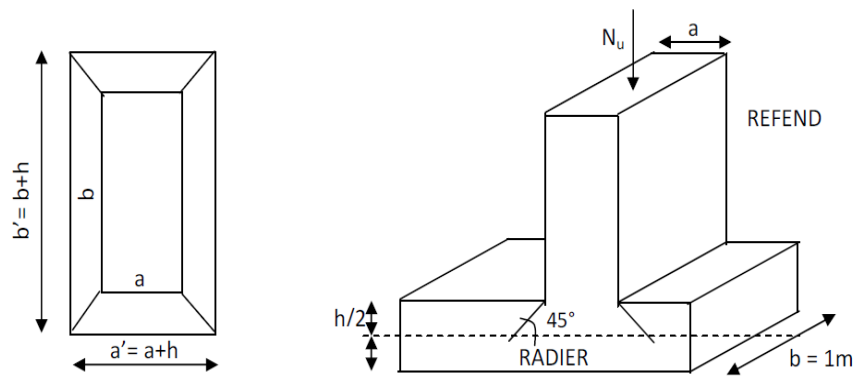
Périmètre utile des voiles et des poteaux.
